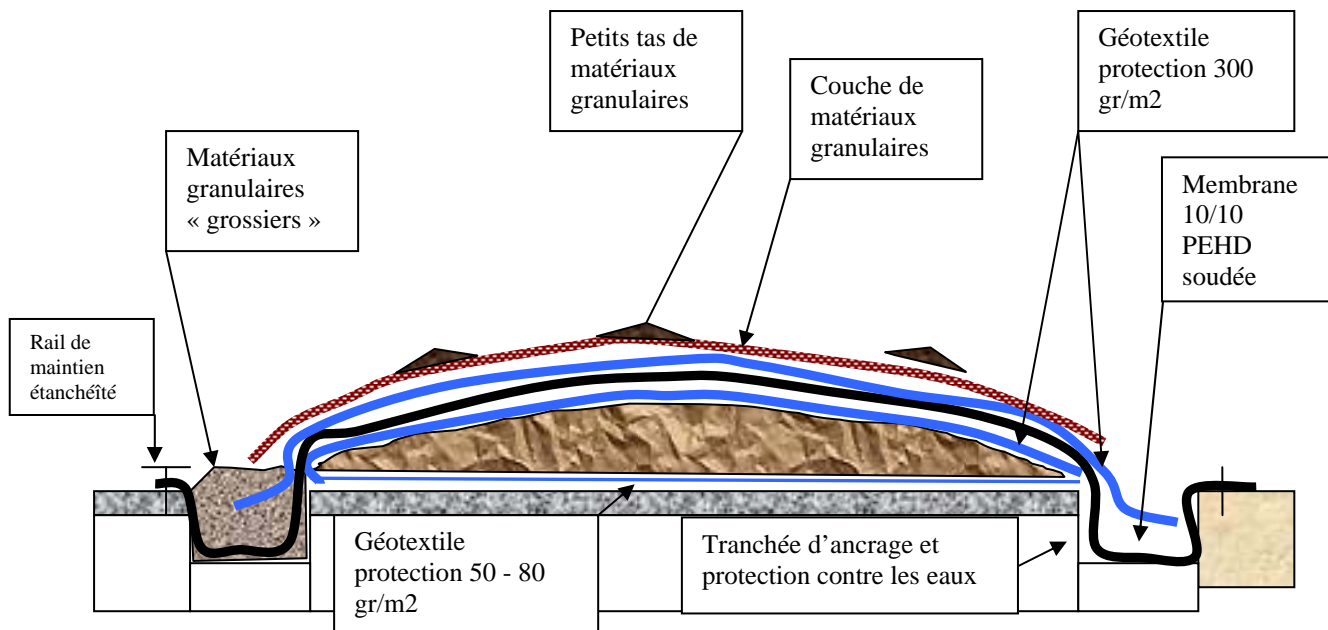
Schéma de principe d'un stockage de matériaux sur dalle béton
